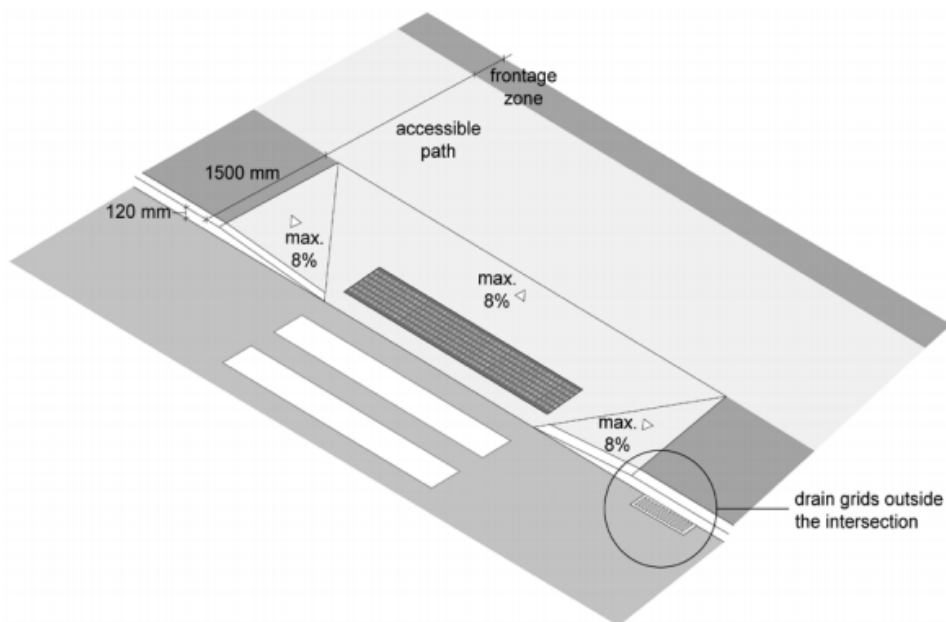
Pormenor de passeio adjacente a travessia pedonal no Dubai (Government of Dubai, 2017, 103)
